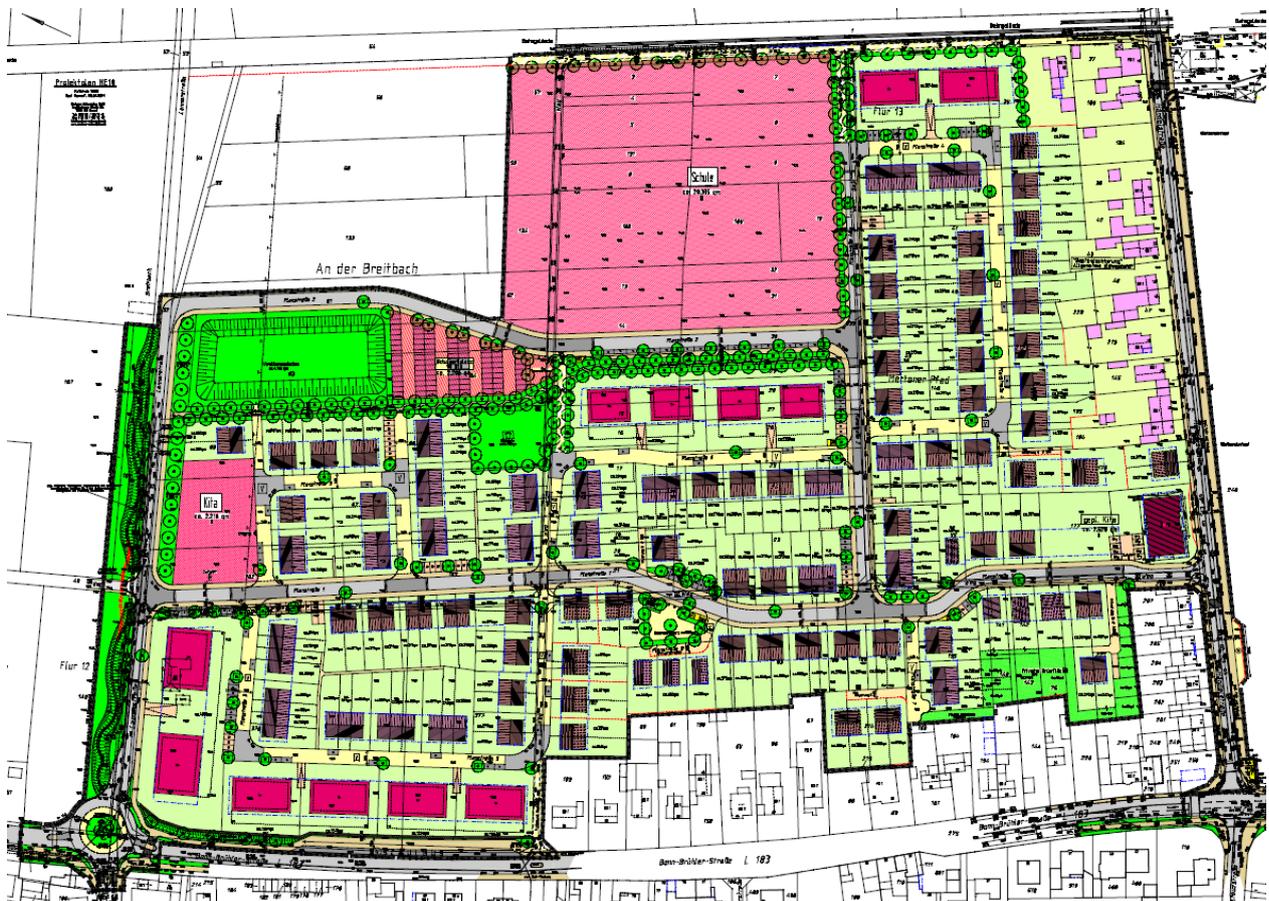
Lageplan – Stand 20.01.2021 [Quelle: Montana Wohnungsbau GmbH]
